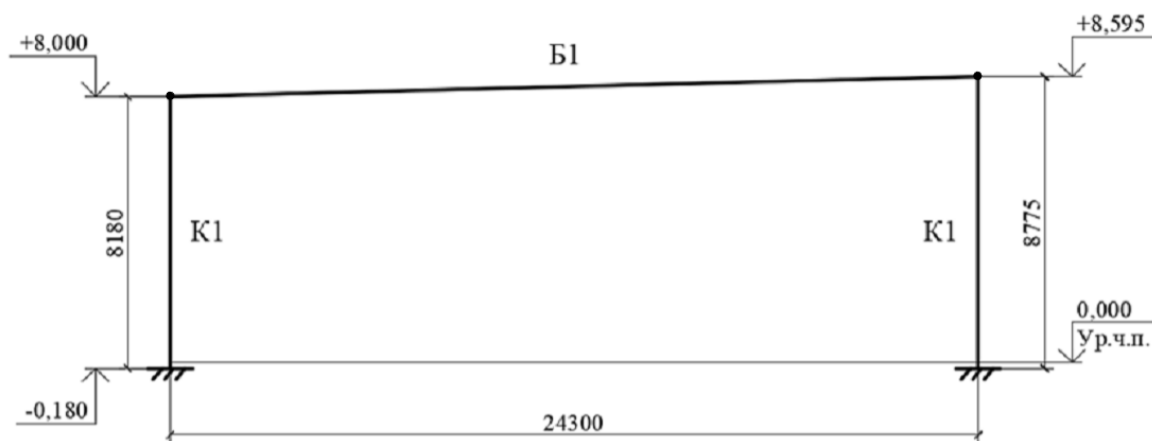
Расчётная схема поперечной рамы каркаса проектируемого здания
